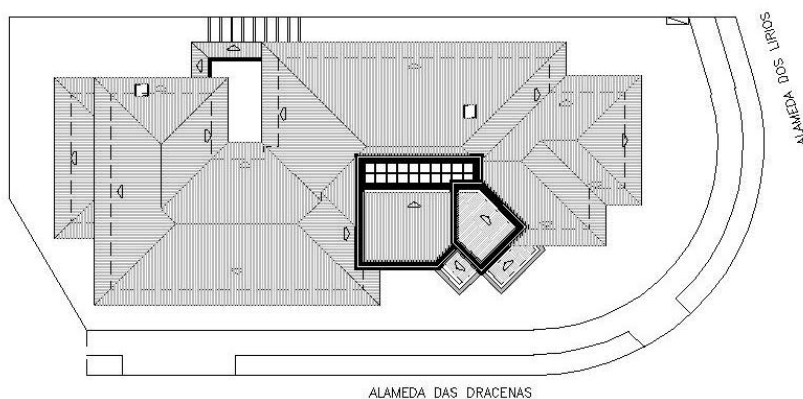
Planta baixa do projeto objeto de pesquisa
